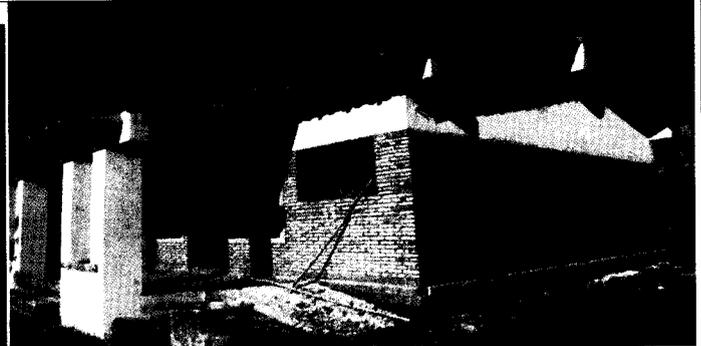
Falta colocación de vidrios e instalación de canaletas
